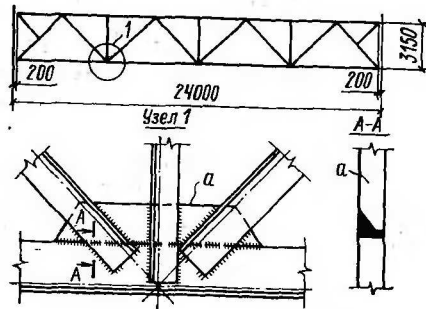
Экспериментальная стропильная ферма пролетом 24 м
